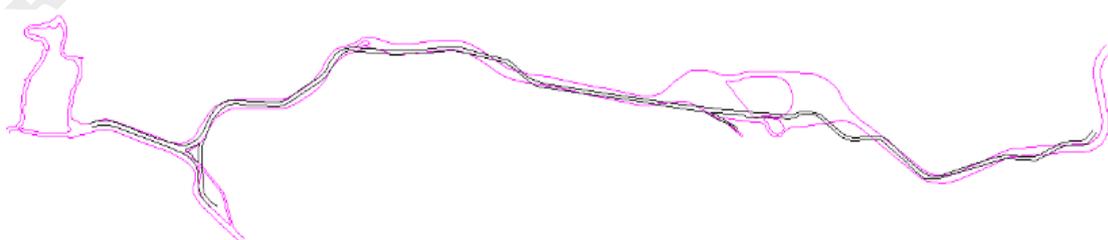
sobreposição entre traçado do projeto Brito (magenta) e do projeto Cintra (preto).
